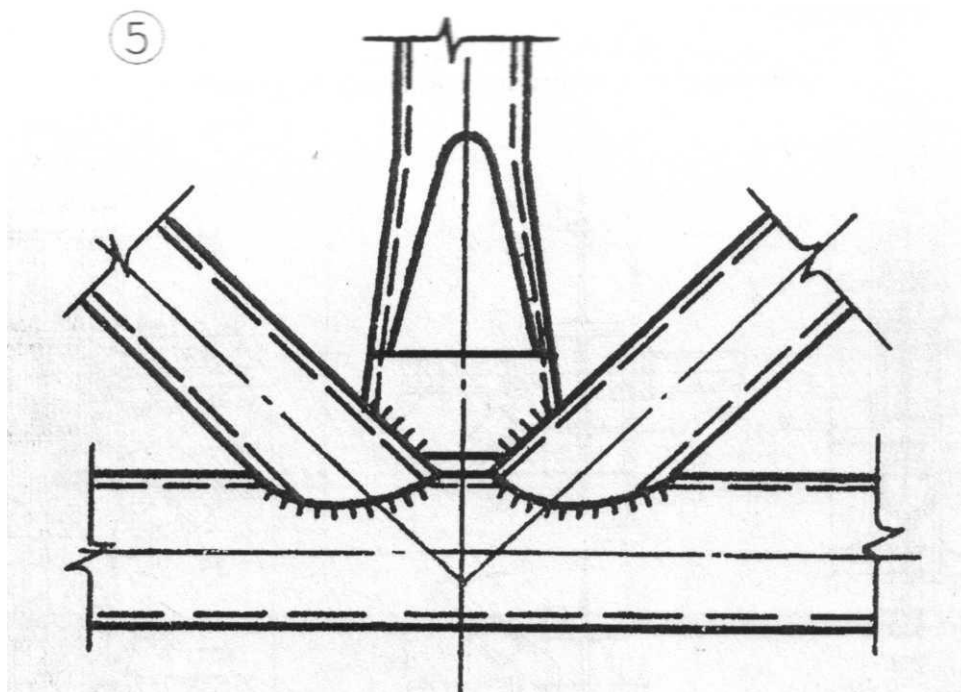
Рядовой узел нижнего пояса фермы из круглых труб
